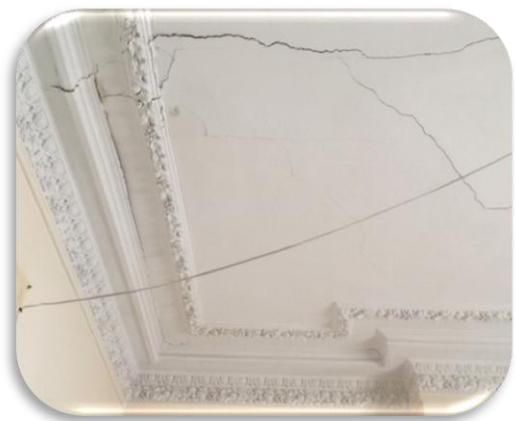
77 : fissures et attaches de rouille dans le plancher
